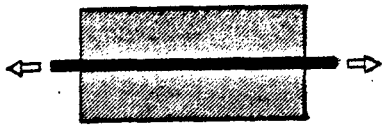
Kraftausstrahlung im Bereich der Betonkonsolen
